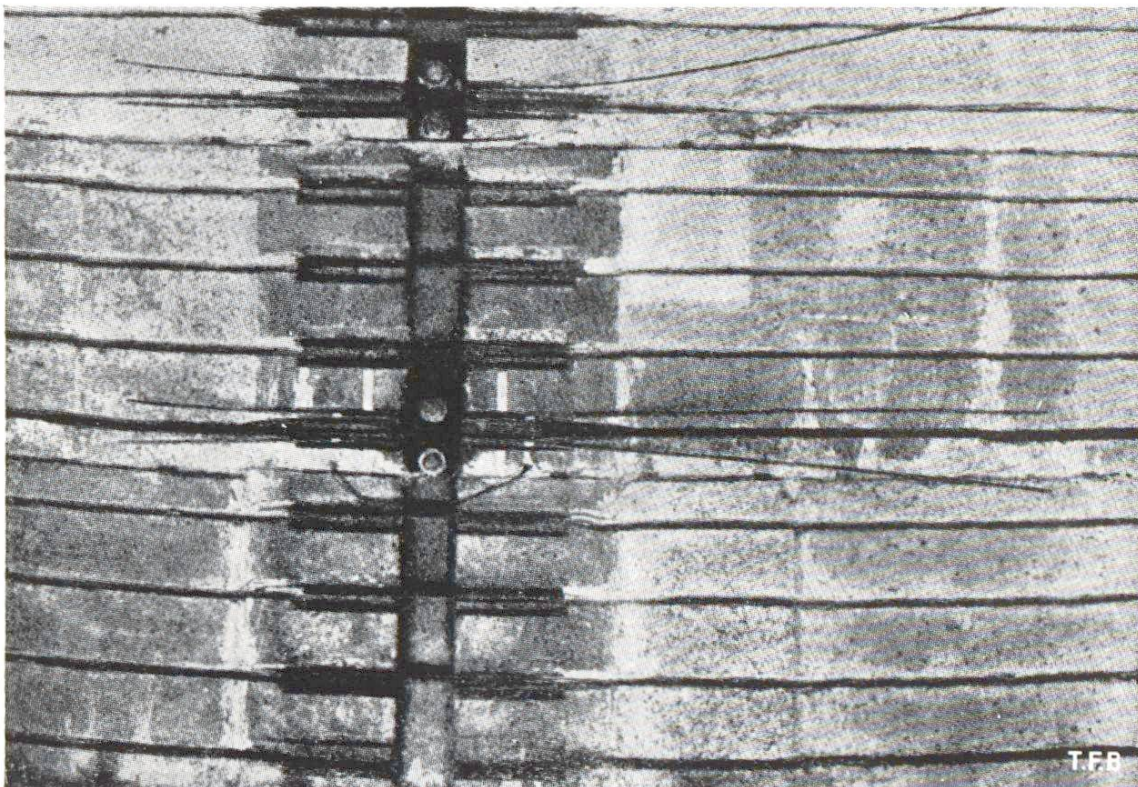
Zylindrischer Eisenbetonbehälter mit vorgespannter Armierung (aus Concrete, Jan. 1946)
